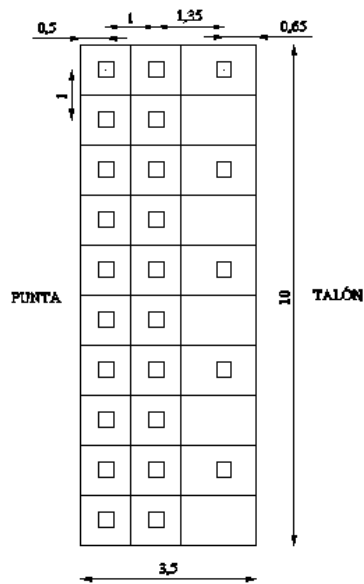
Distribución de los pilotes en el muro de mampostería.
